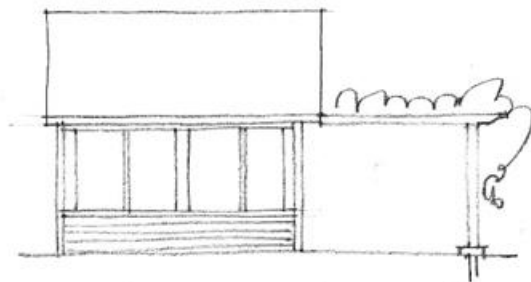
VÉRANDA PRÉFABRIQUÉE (SOLARIUM)
